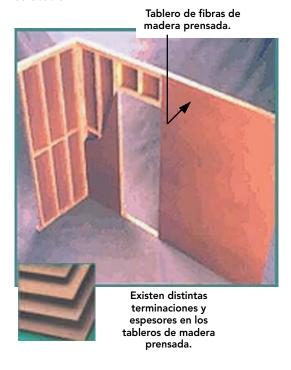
24: Revestimiento con paneles de madera prensada.
